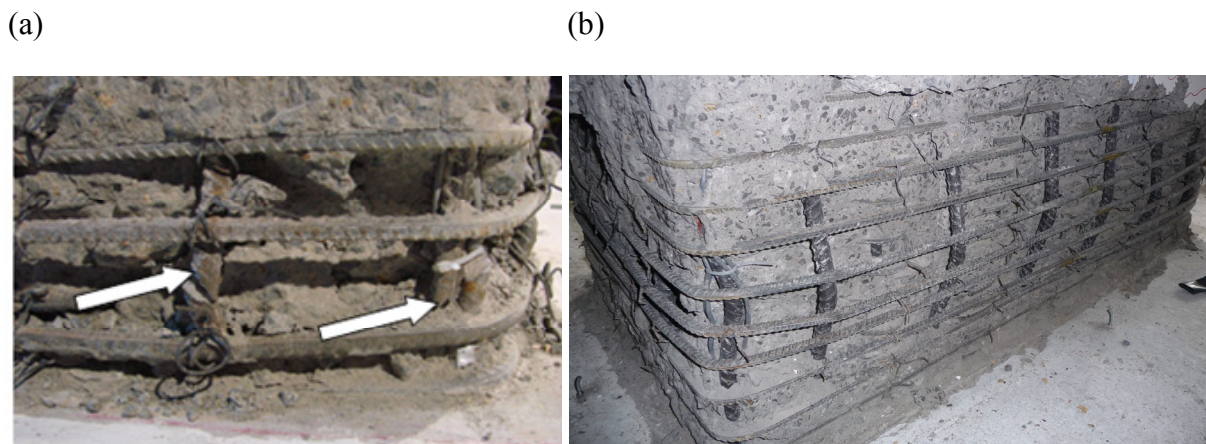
(a) Rupture des barres du spécimen S1; (b) Flambage hors plan des barres non soutenues et dans le plan des barres de coin du spécimen S3.
